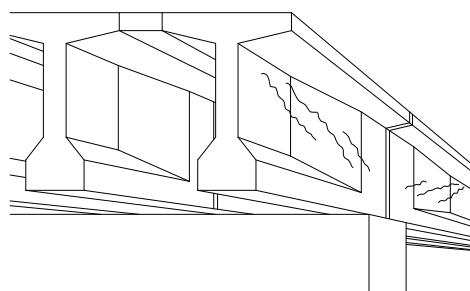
支間中央部曲げひび割れ
